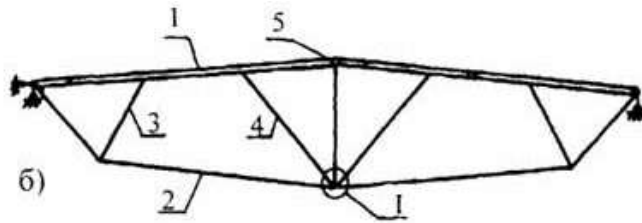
Малоэлементная шпренгельная ферма 1 – верхний пояс; 2 – нижний пояс; 3 – приопорный шпренгель; 4 – коньковый шпренгель; 5 – шарнир
